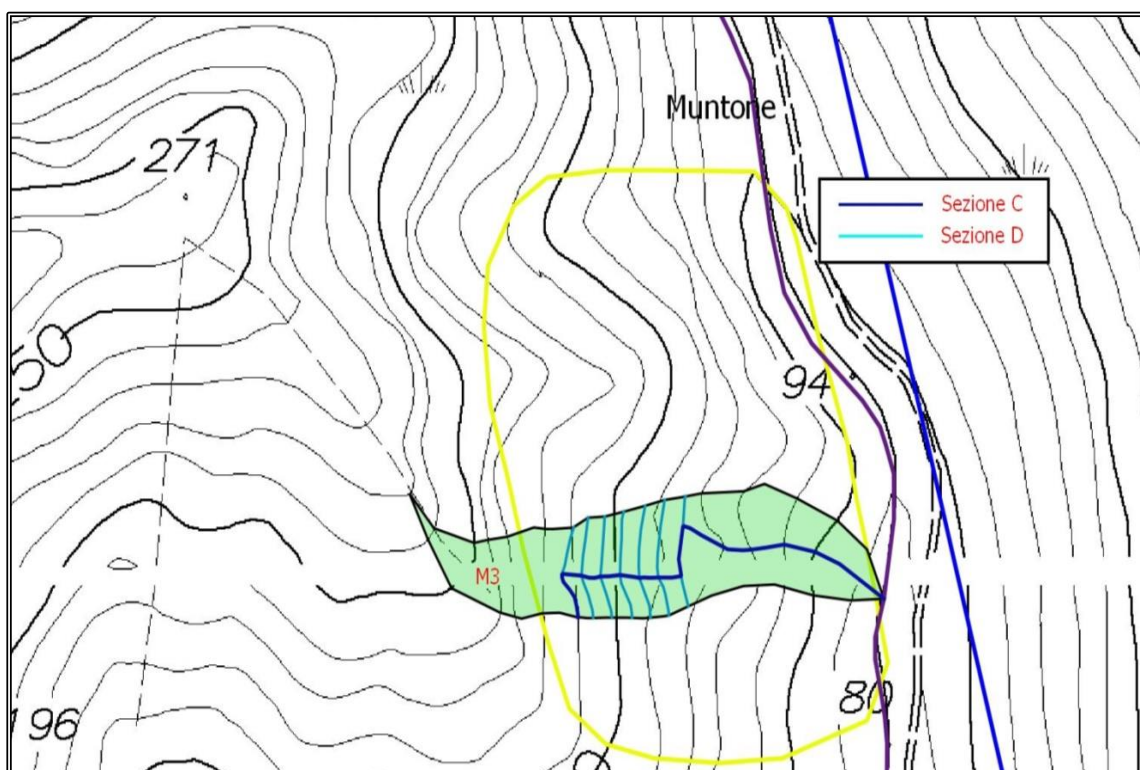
Schema della rete di drenaggio, con tipologia di sezione trasversale di progetto (Cantiere di Muntone M3).
